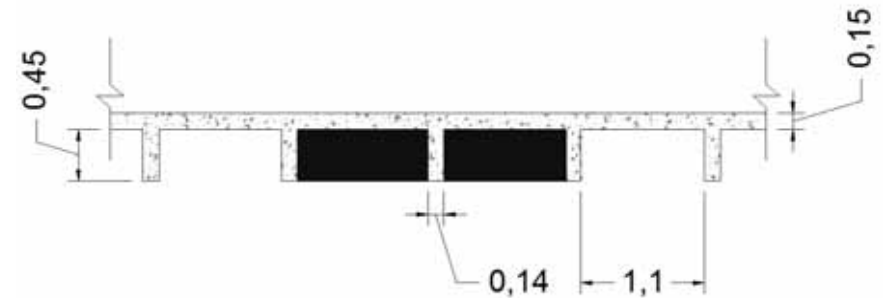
Corte da laje nervurada inferior. Medidas em metros.
